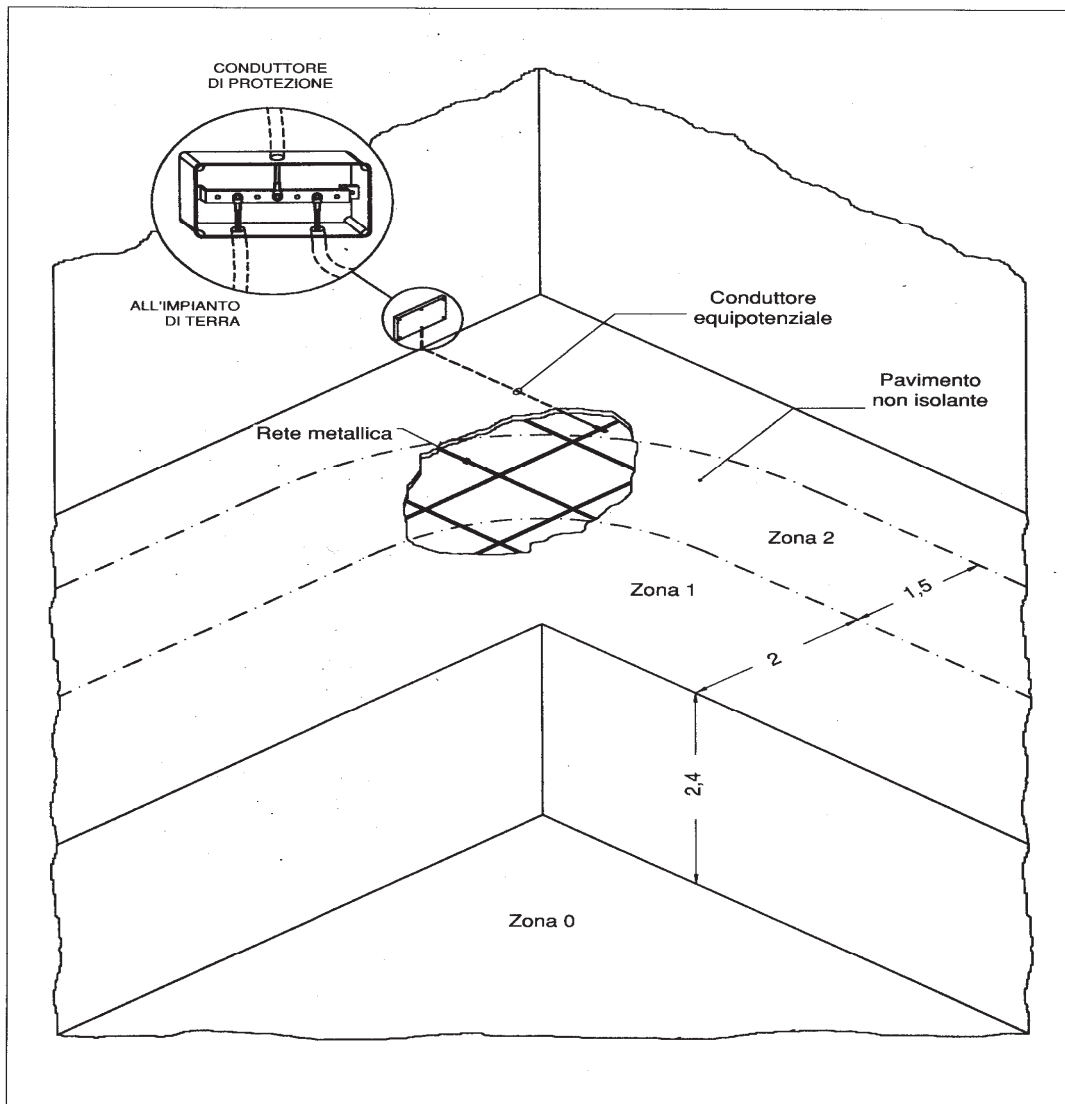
Collegamento equipotenziale supplementare del pavimento non isolante, realizzato con griglia metallica collegata al conduttore di protezione (dimensioni in metri).
